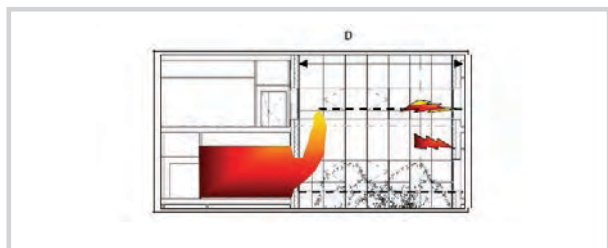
rayonnement thermique sur la façade en vis-à-vis
